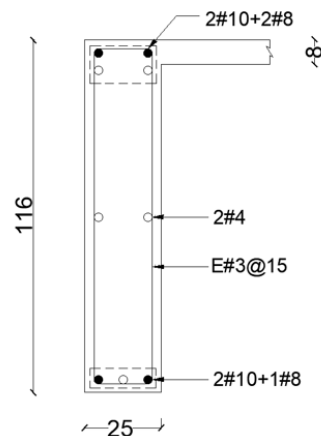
Ejemplo de sección transversal de viga de acoplamiento (adaptado de SRE, 1963).
